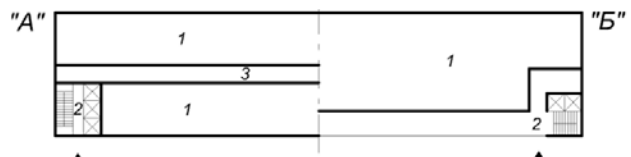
Коридорный (А) и галерейный (Б) многоэтажный жилой дом. Схематический план (slab block with corridor (A) and balcony access (B): 1-Жилые квартиры, 2-лестнично-лифтовые узлы, 3-внутренний этажный коридор, 4-галерея.
